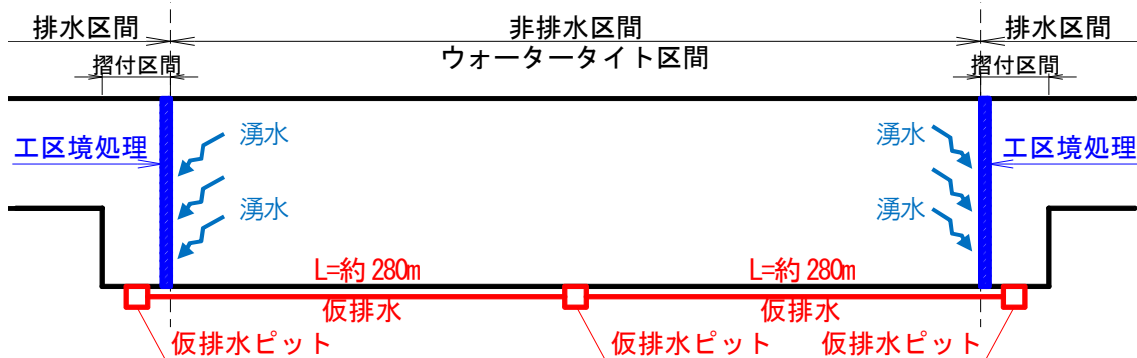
湧水仮排水設備と工区境処理位置 (縦断面図)
